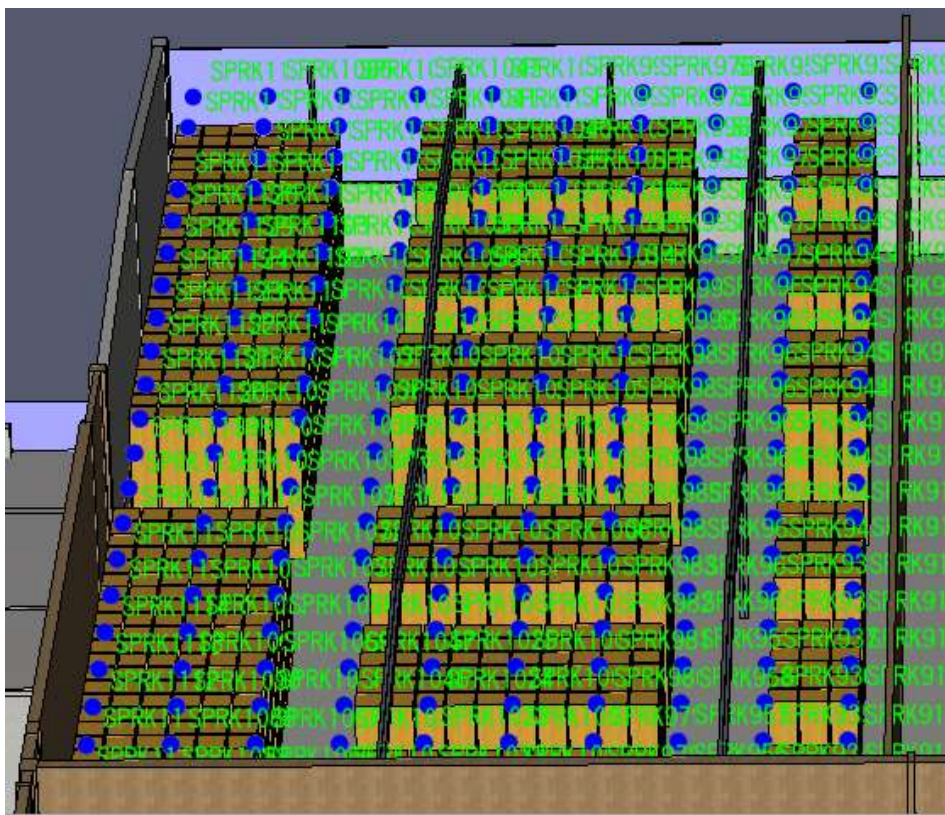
Pormenor dos sprinklers do armazém de paletes
